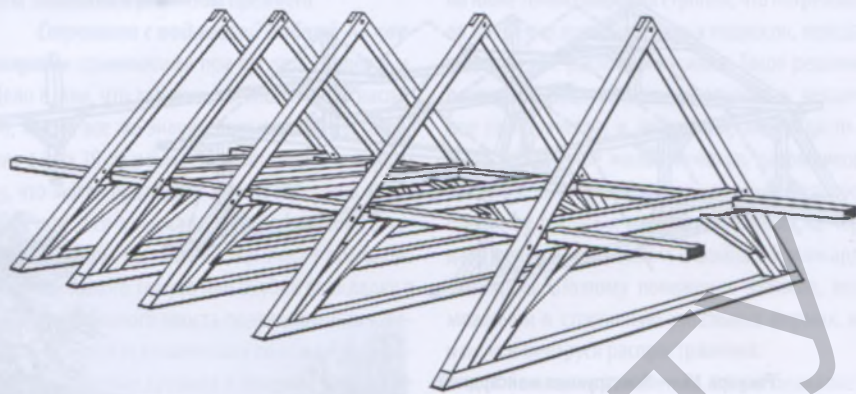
Конструкция крыши со стропильно-ригельной фермой, у которой ригель поддерживается подкосами. Дом вице-администратора в Гродно, XVIII в.
